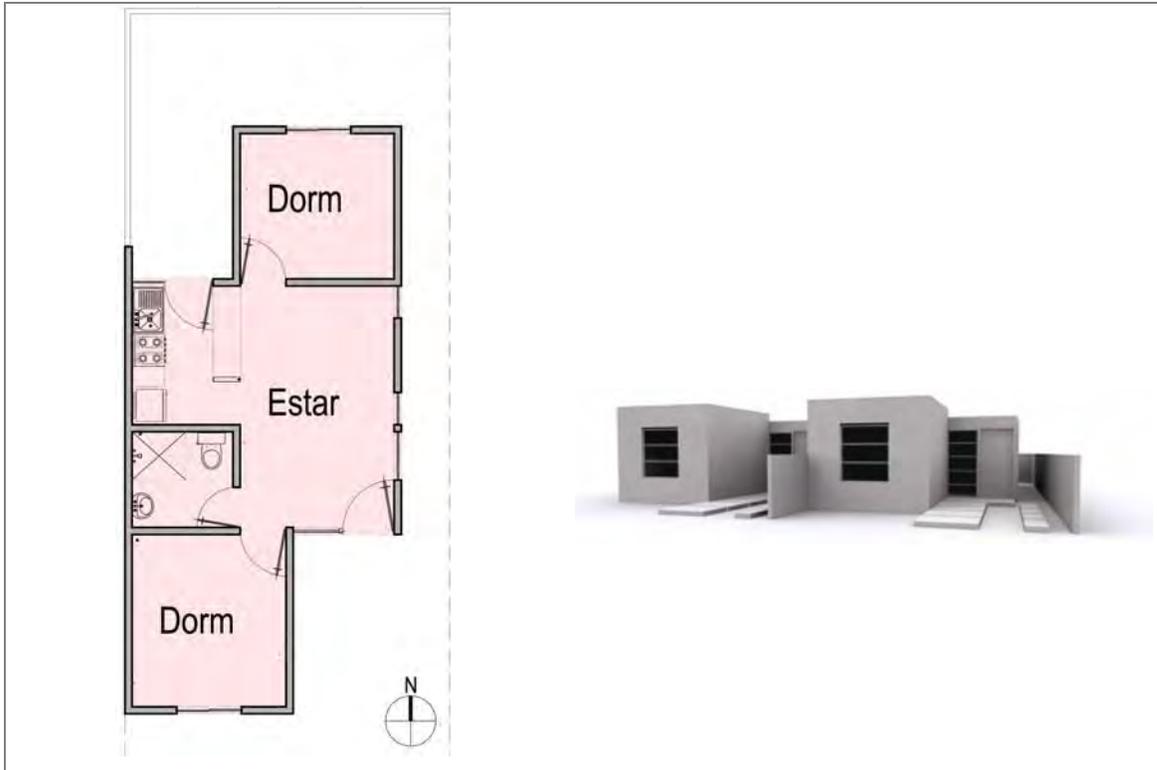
Tipo de vivienda aislada. Planta arquitectónica y 3D, sin escala
